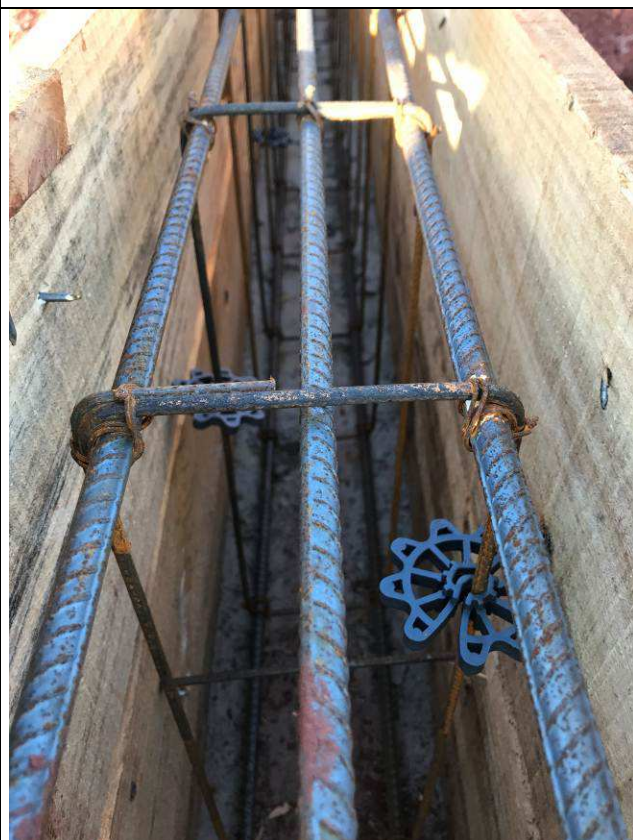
C: Formas e armaduras das vigas baldrames do prédio do arquivo.
